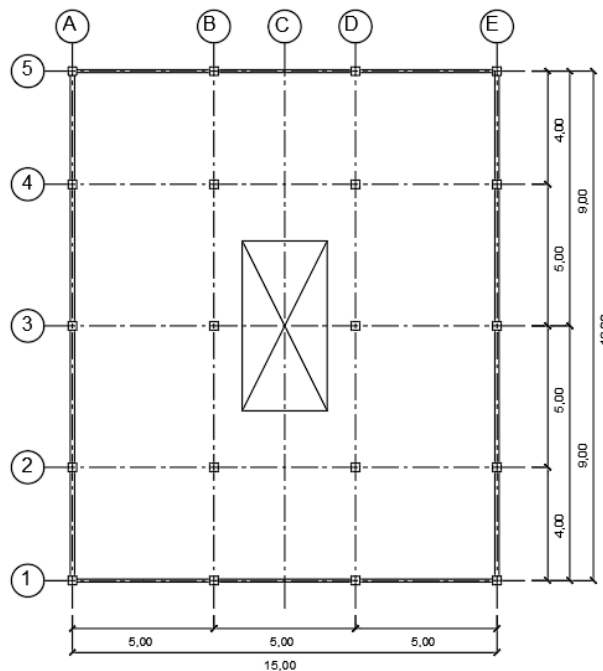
Planta baja del modelo estructural, cotas en metros.
